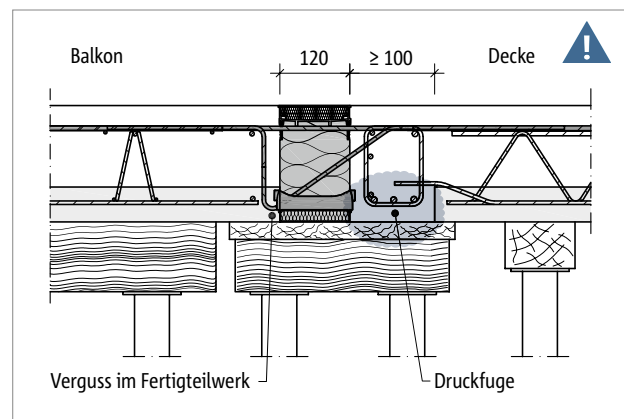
Schöck Isokorb® XT Typ K: Indirekte Lagerung, Einbau in Verbindung mit Halffertigteilplatten (hier:  $h \leq 180$  mm), Druckfuge deckenseitig
